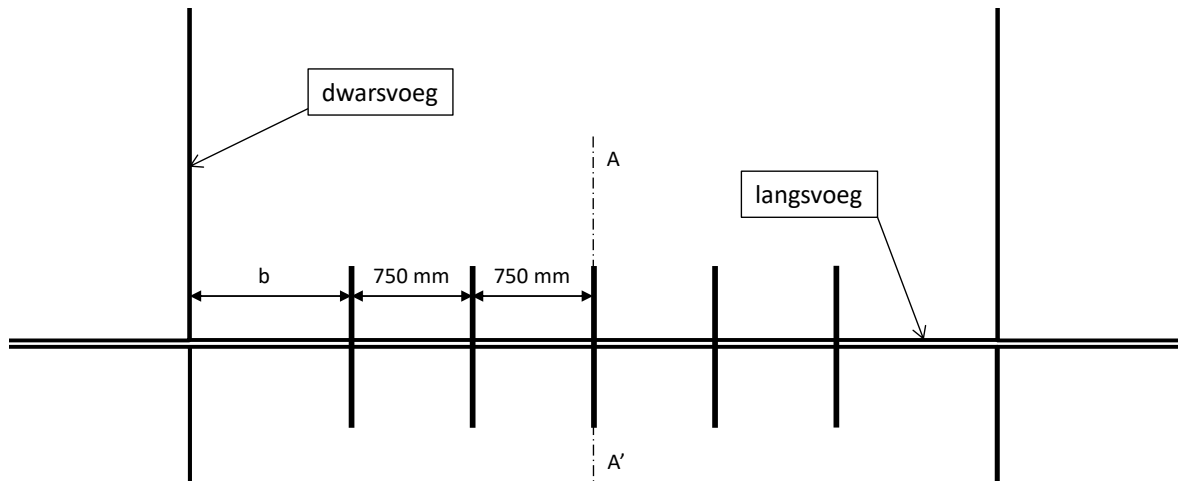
detail van de lange buigingsvoeg (alle maten in mm)
